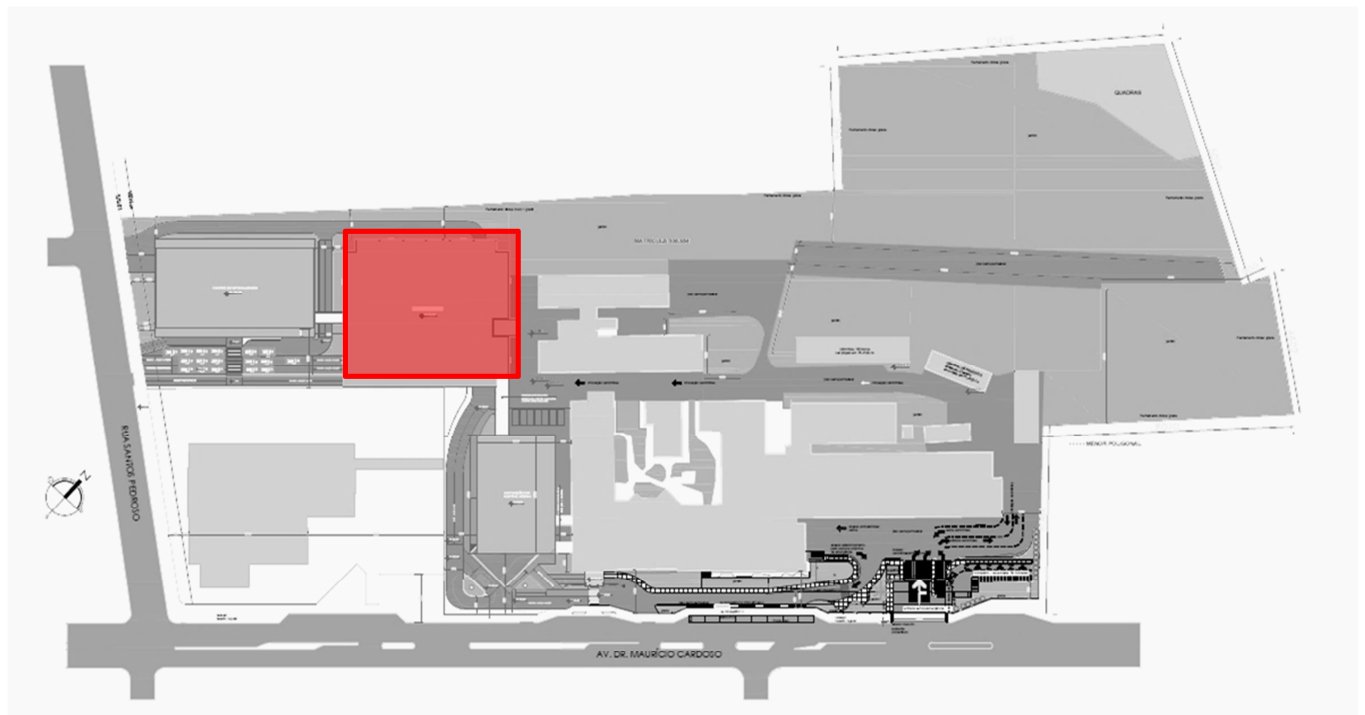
Implantação Prédio Garagem. Fonte Acervo do empreendedor.
